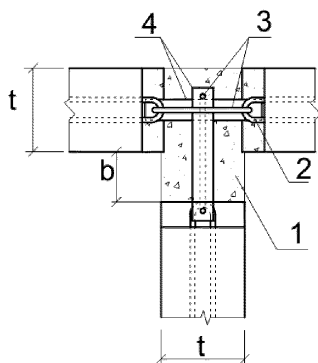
Соединение трех панелей: 1 – бетон замоноличивания; 2 – петлевые арматурные выпуски; 3 – соединительные скобы; 4 – соединительная пластина; b – 100–120 мм; t – толщина стены (140–250 мм)
